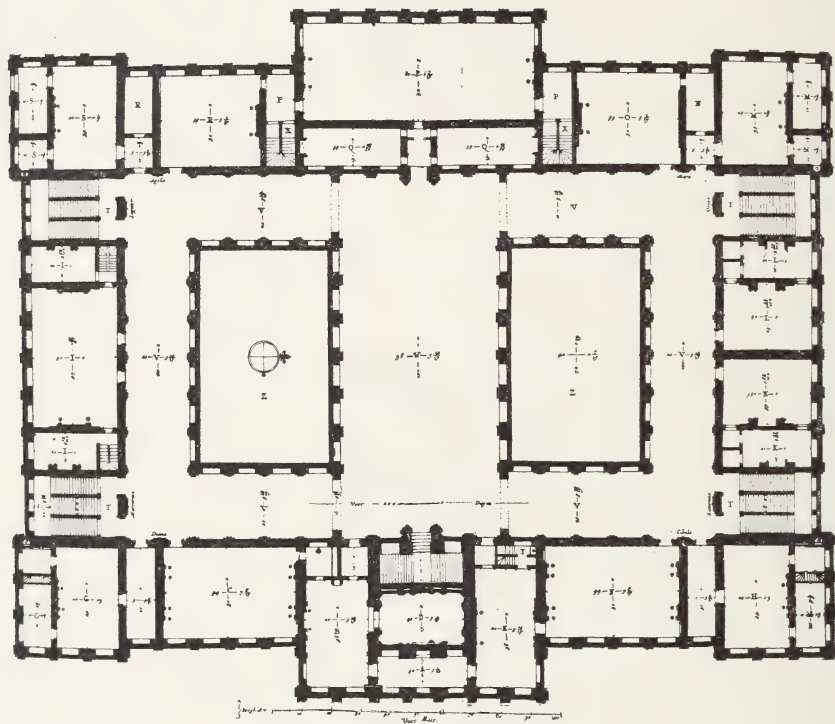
Grundriß. Rathaus zu Amsterdam.
